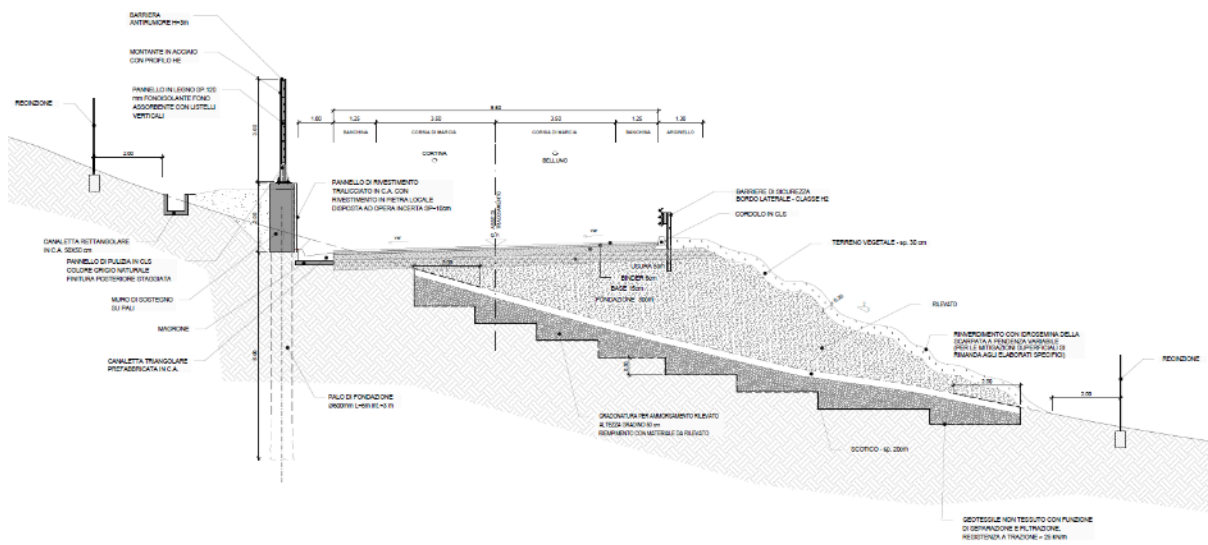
Asse Principale - Sezione tipo a mezzacosta con barriera antirumore su muro
